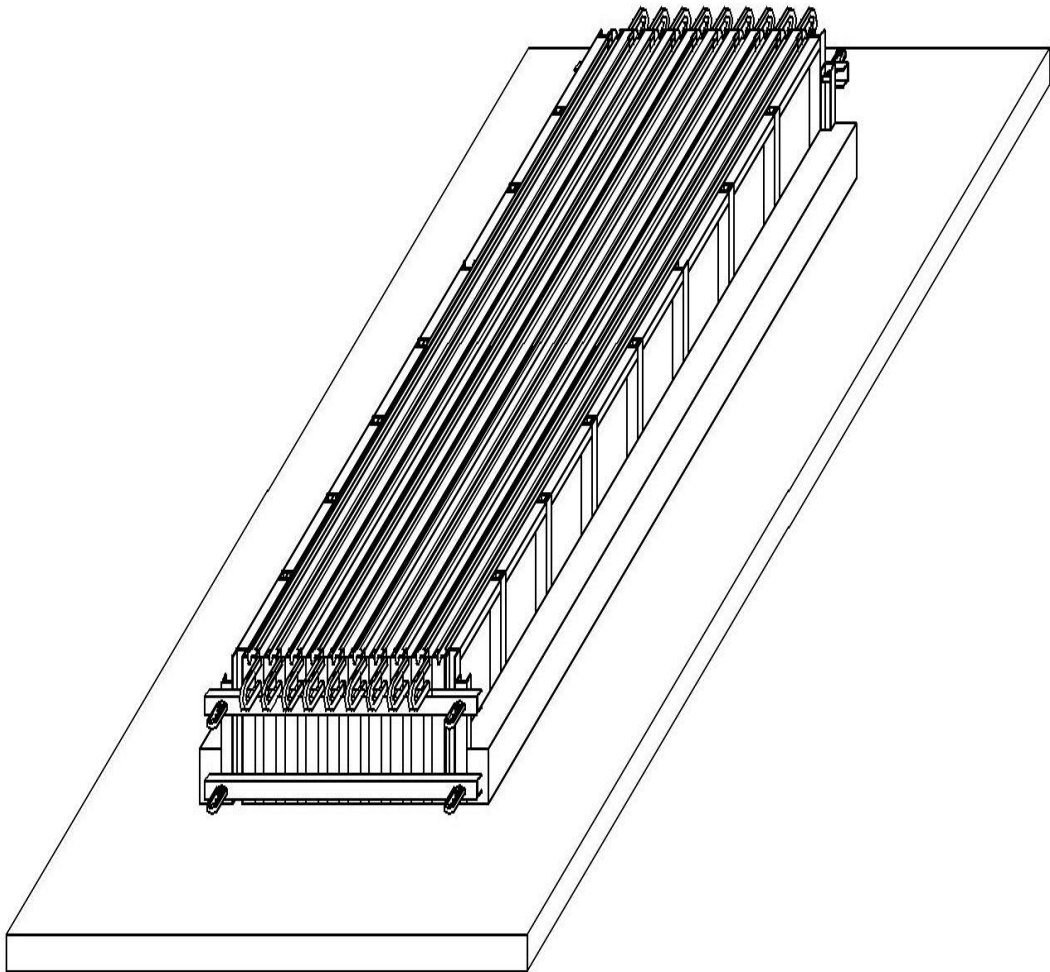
Detail sambungan baut terpasang pada bekisting baja
